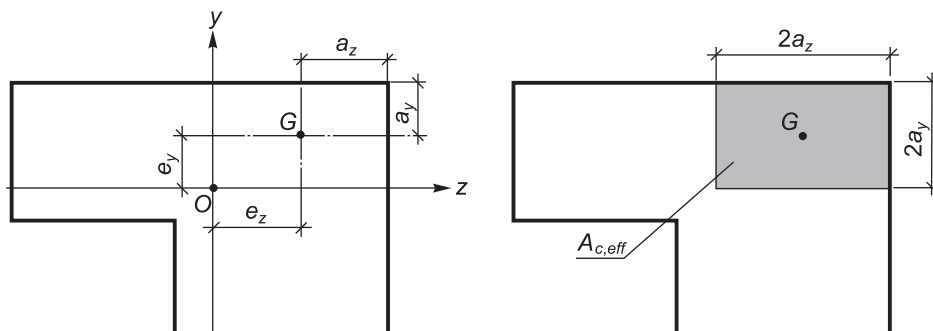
Схемы для определения эффективной площади поперечного сечения при расчете бетонных элементов на косое внецентренное сжатие
